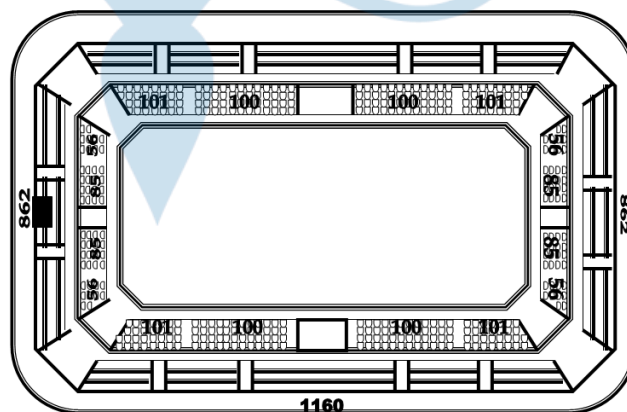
Denah Lantai 1 Gedung Olahraga UNY
